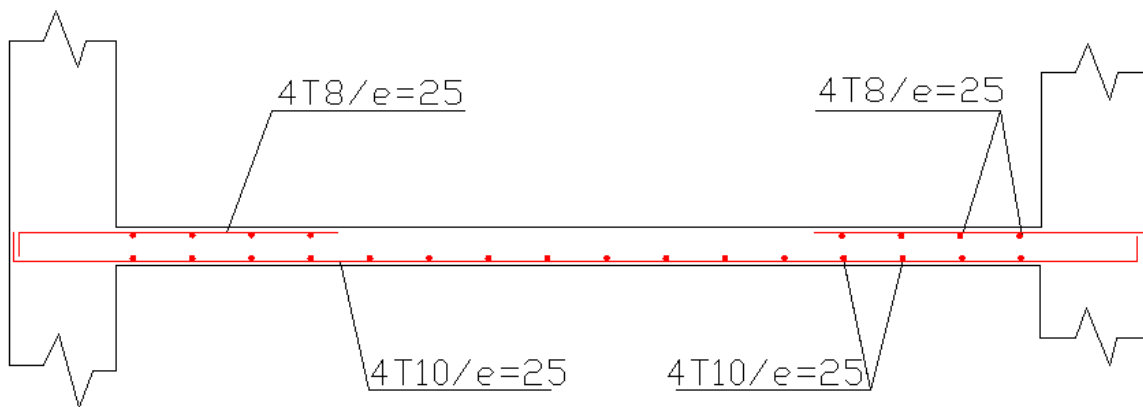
Ferrailage de la dalle pleine dans les sens x-x et y-y
